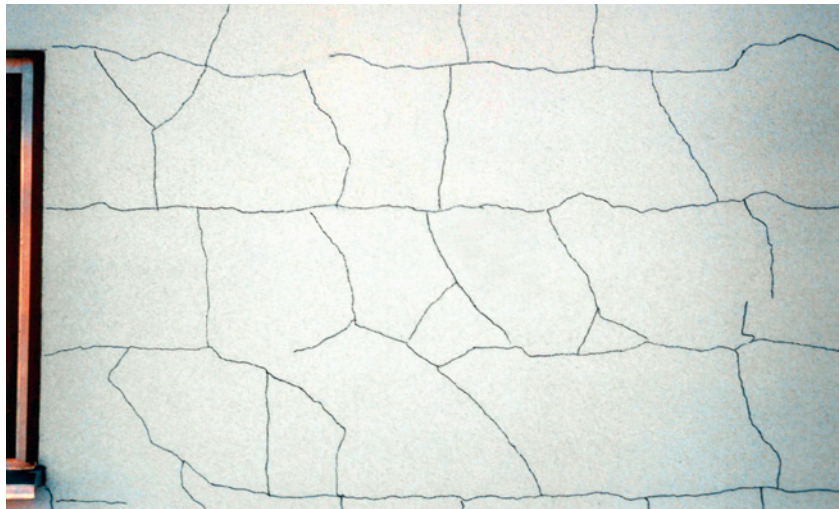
Fugen- und Kerbrisse (nachgezeichnet) im Außenputz auf Mauerwerk aus Porenbeton (Versuchshaus). Die Lagerfugen sind fast durchgehend erkennbar. Infolge Kerbwirkung pflanzen sich Stoßfugenrisse zum Teil in angrenzenden Steinlagen fort. [1]
